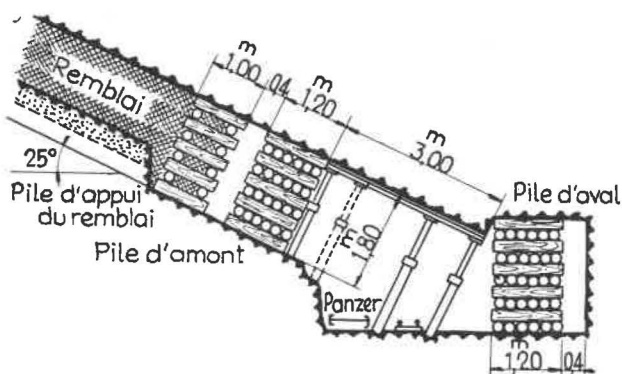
Coupe du pied de taille avec soutènement provisoire et piles de soutènement.
